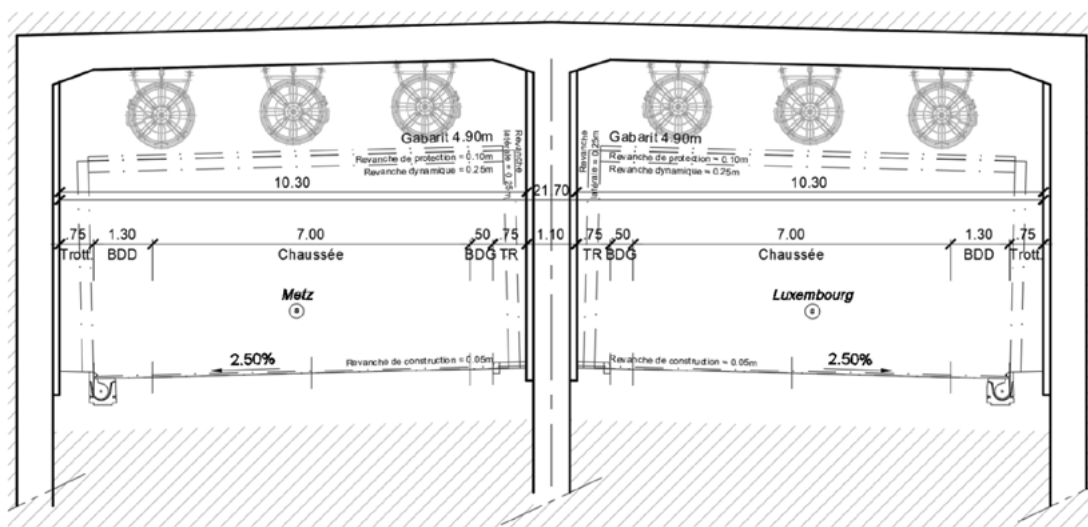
Profil en travers du tunnel de surface – Variante F5-Tunnel de surface
